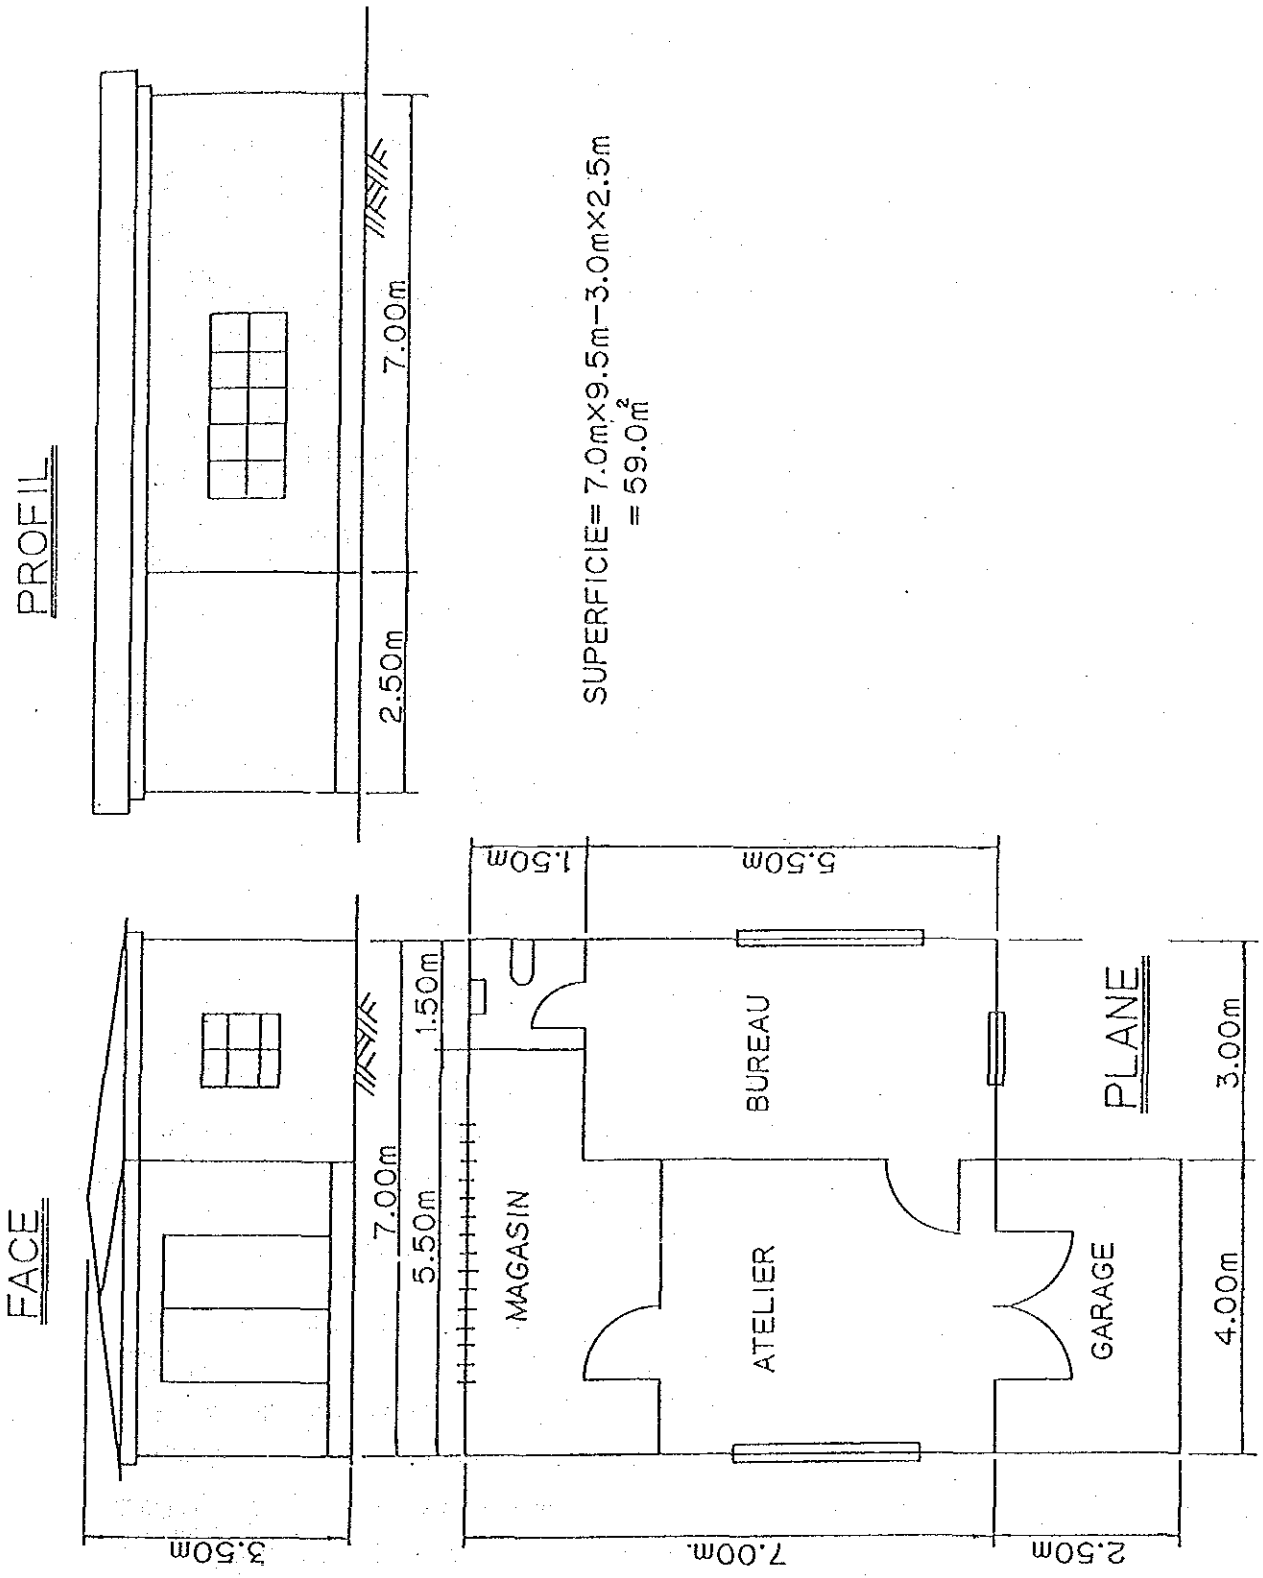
PLAN TYPE DU CENTRE DE MAINTENANCE
